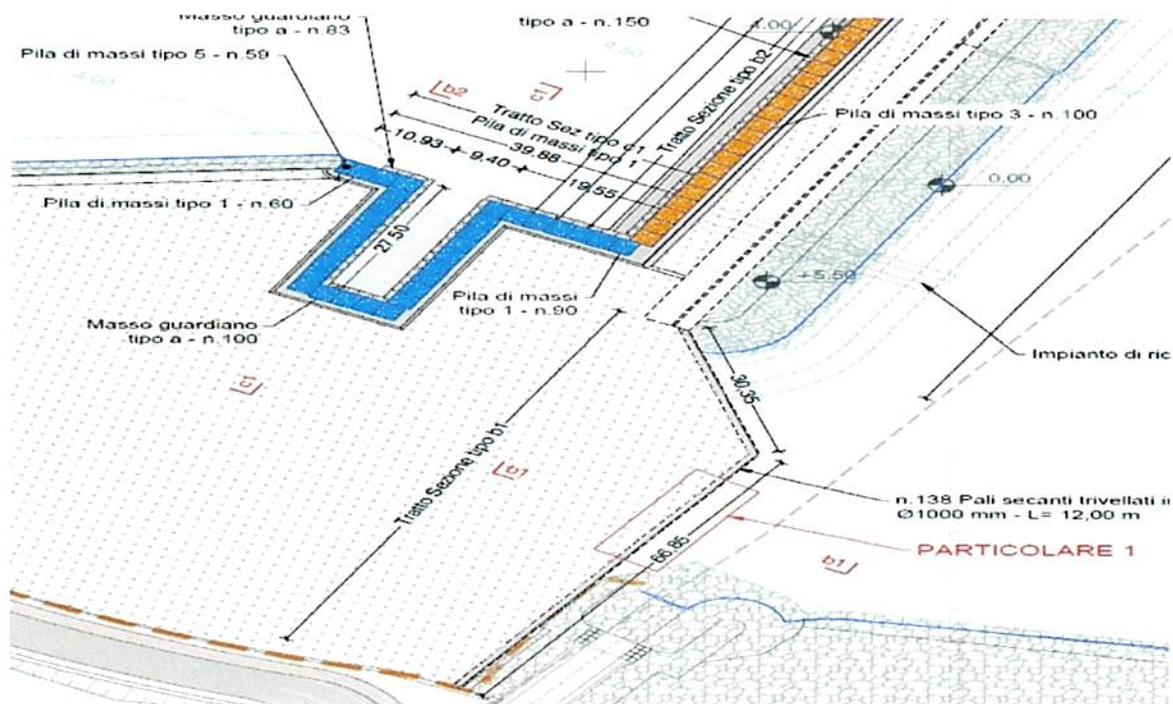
stralcio della diga sottoflutto - Planimetria progettuale OO.MM. (tav. EG\_OME 7\_3)
